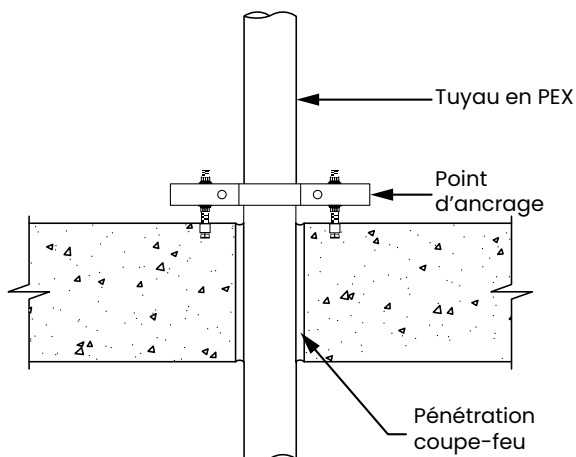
Exemple de point d'ancrage 1 (tuyauterie verticale)
